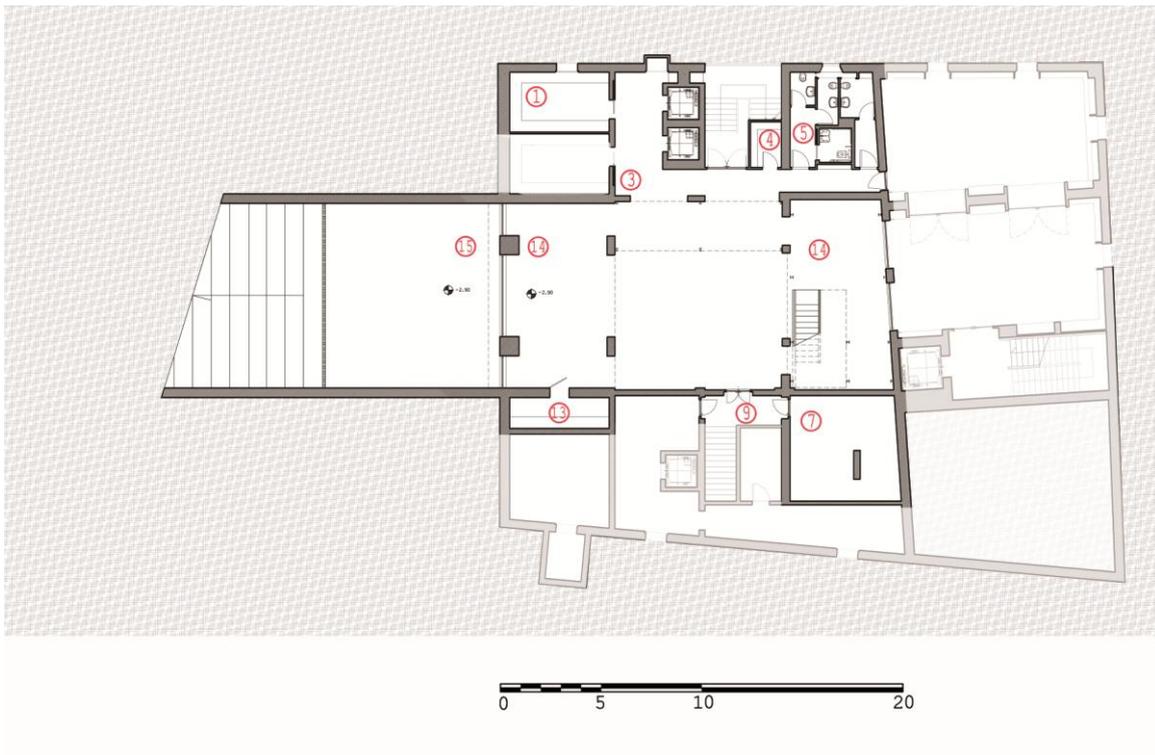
Nuovi Spazi. Piano interrato. Progetto
